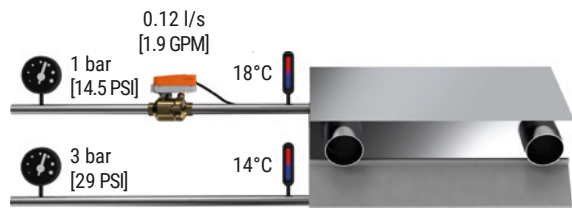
Kühlbalken mit einem mechanischen PI-Ventil.
